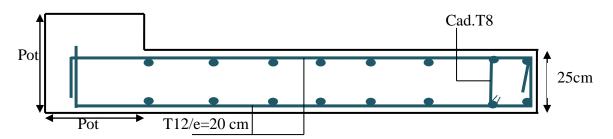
Ferraillage de voile le voile V5 du 1^{ére} sous sol et RDC.
